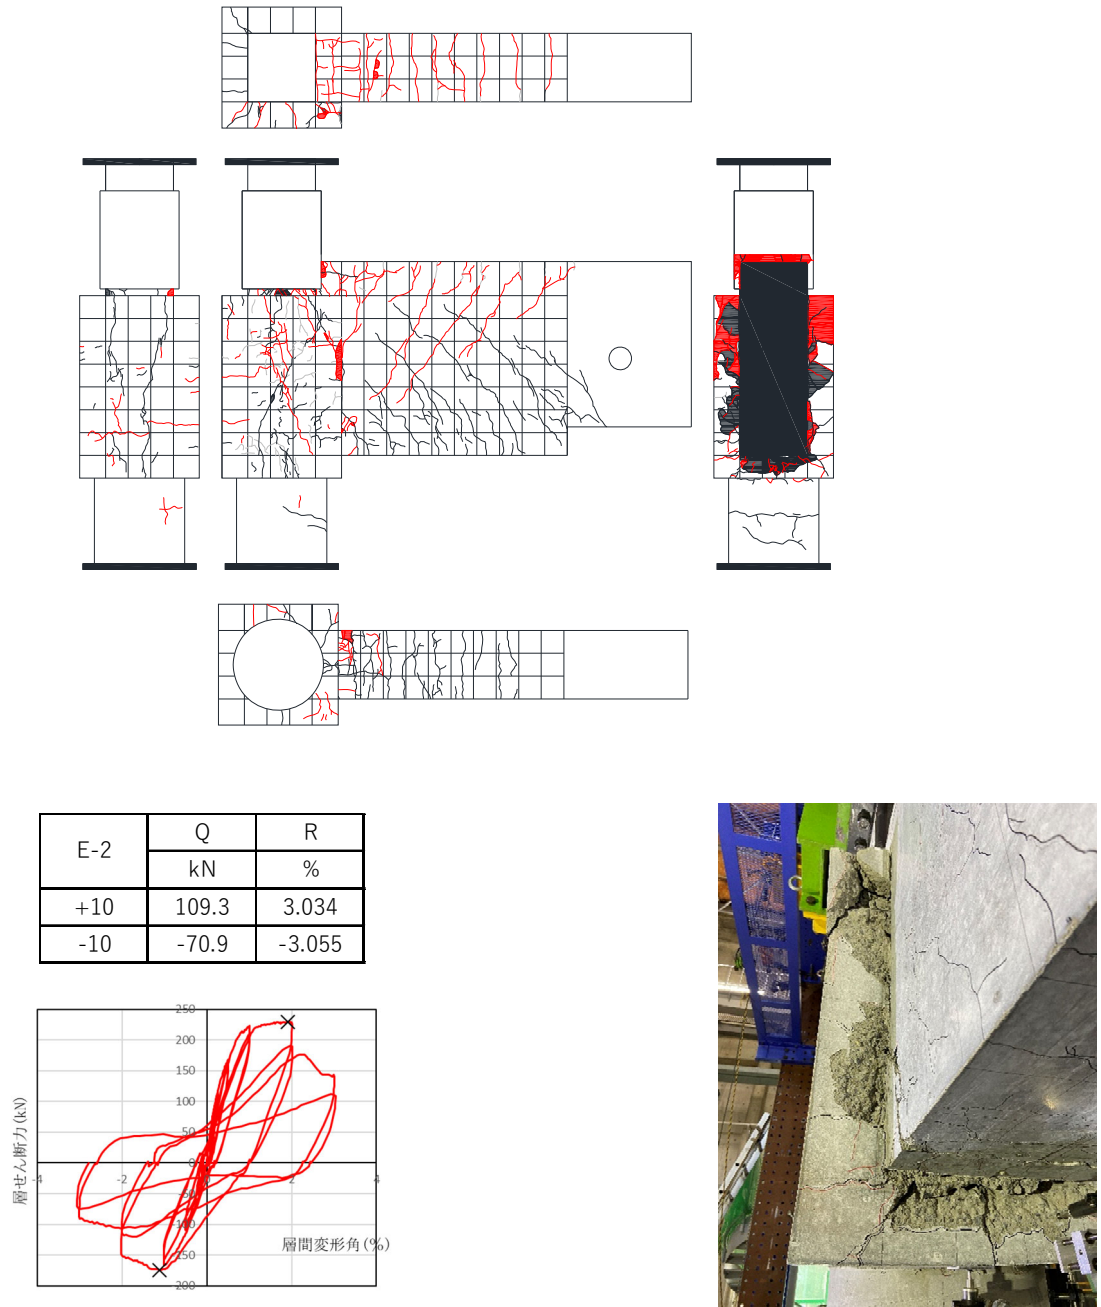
E-2 ひび割れ状況 (7 Cycle)
